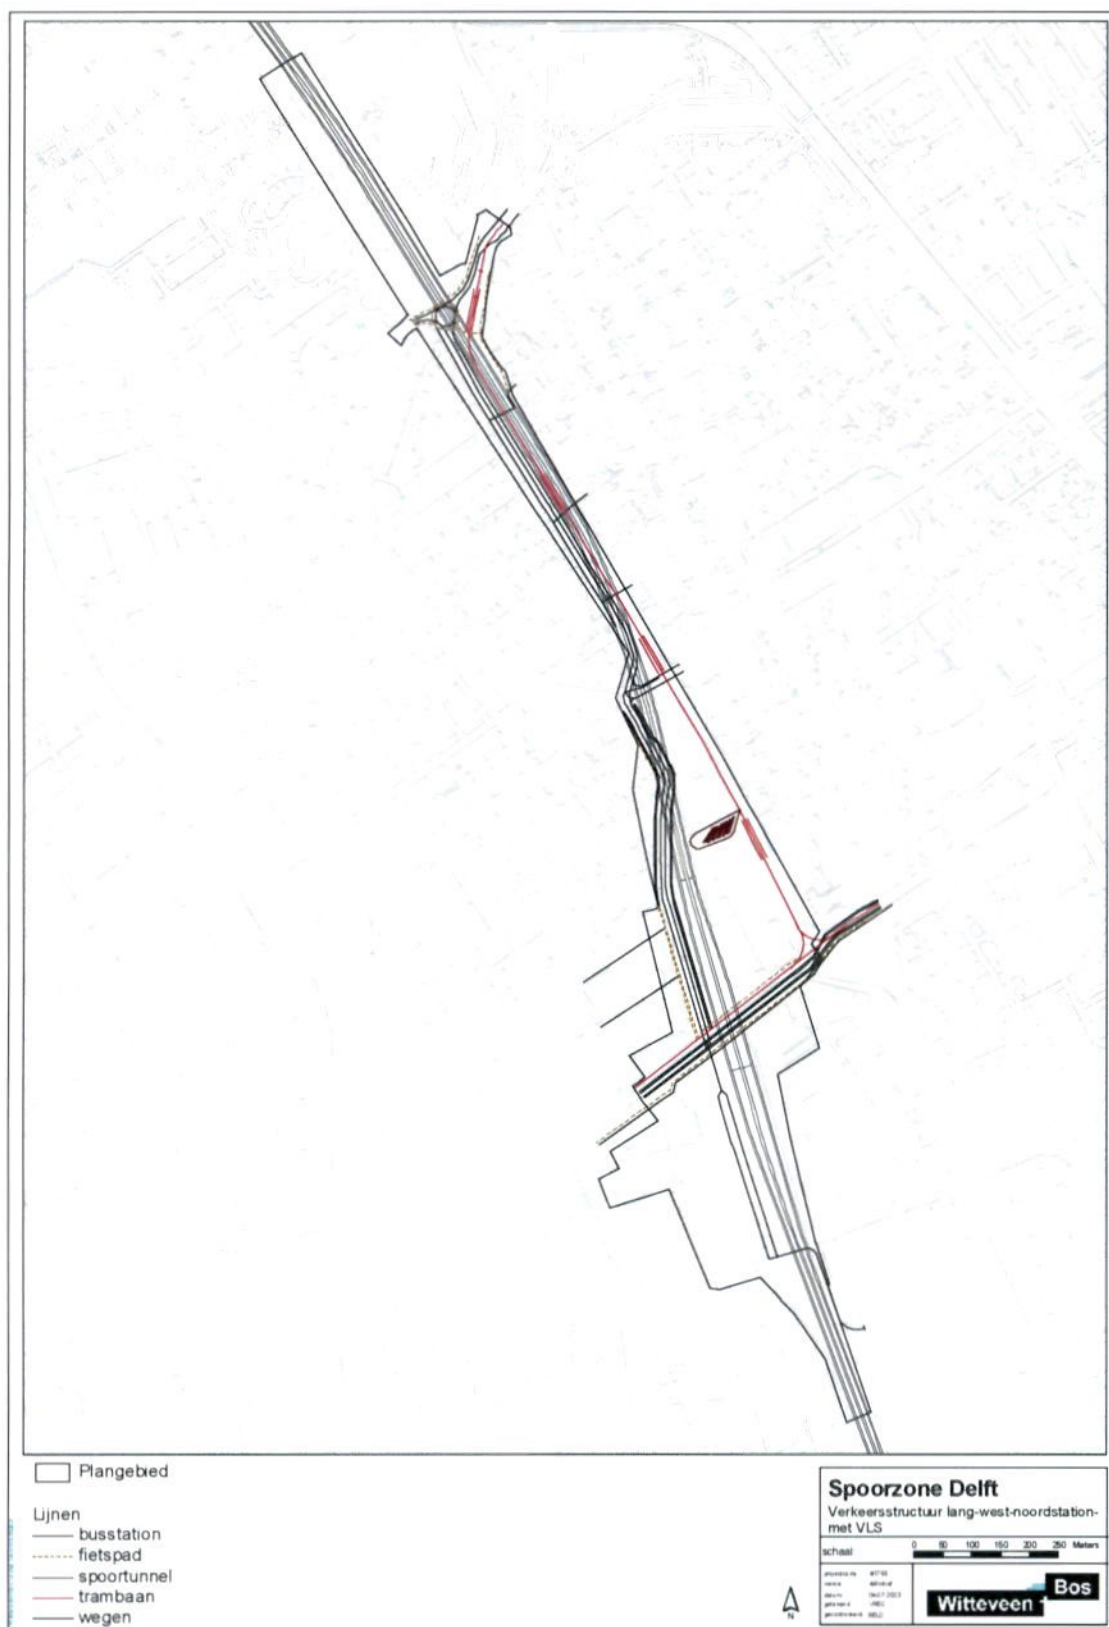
LWN: Lange tunnel, westelijk tracé en noordelijk gepositioneerd station
